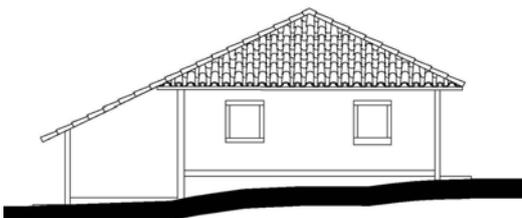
Fachada Noroeste (Acervo PROAU/FAU/UnB).
